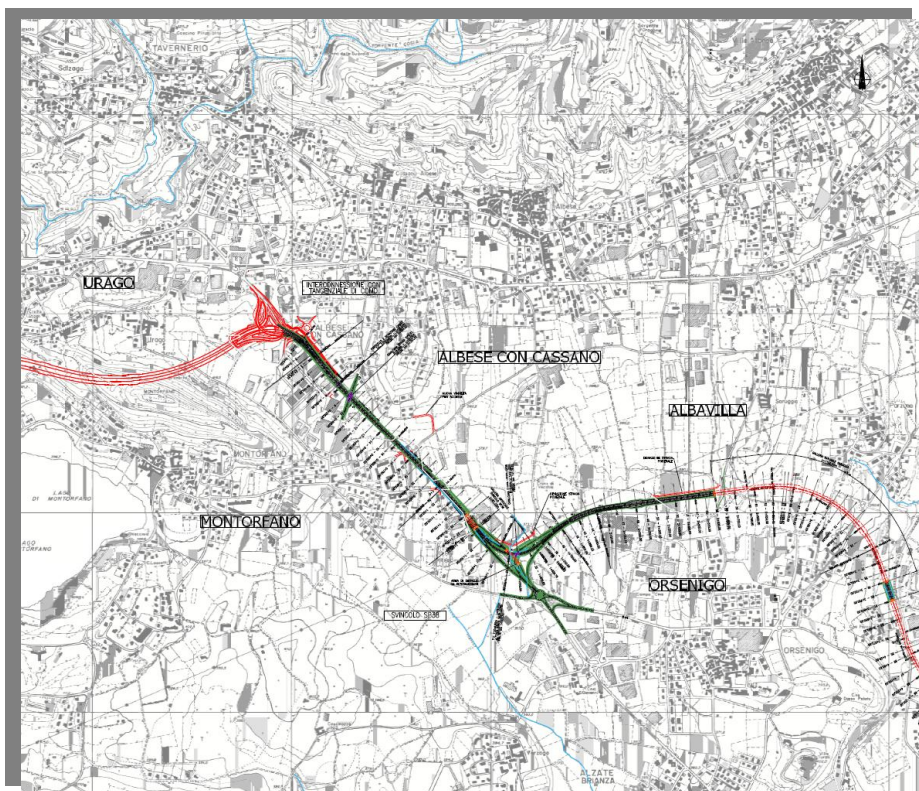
Ipotesi con collegamento dalla fine del secondo lotto della “Tangenziale di Como”
